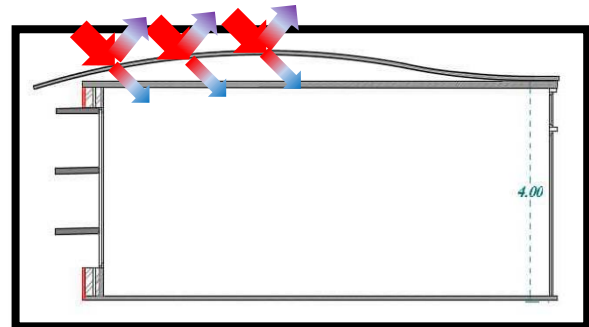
coupe sur atelier toiture ventilée,source l'auteur
